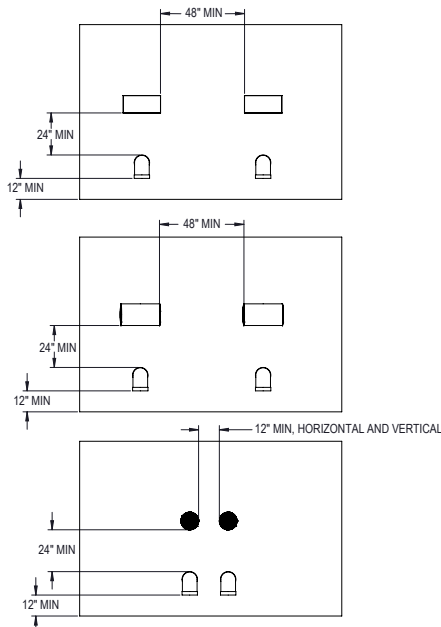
Dégage ment de ventilation horizontaux et verticaux
